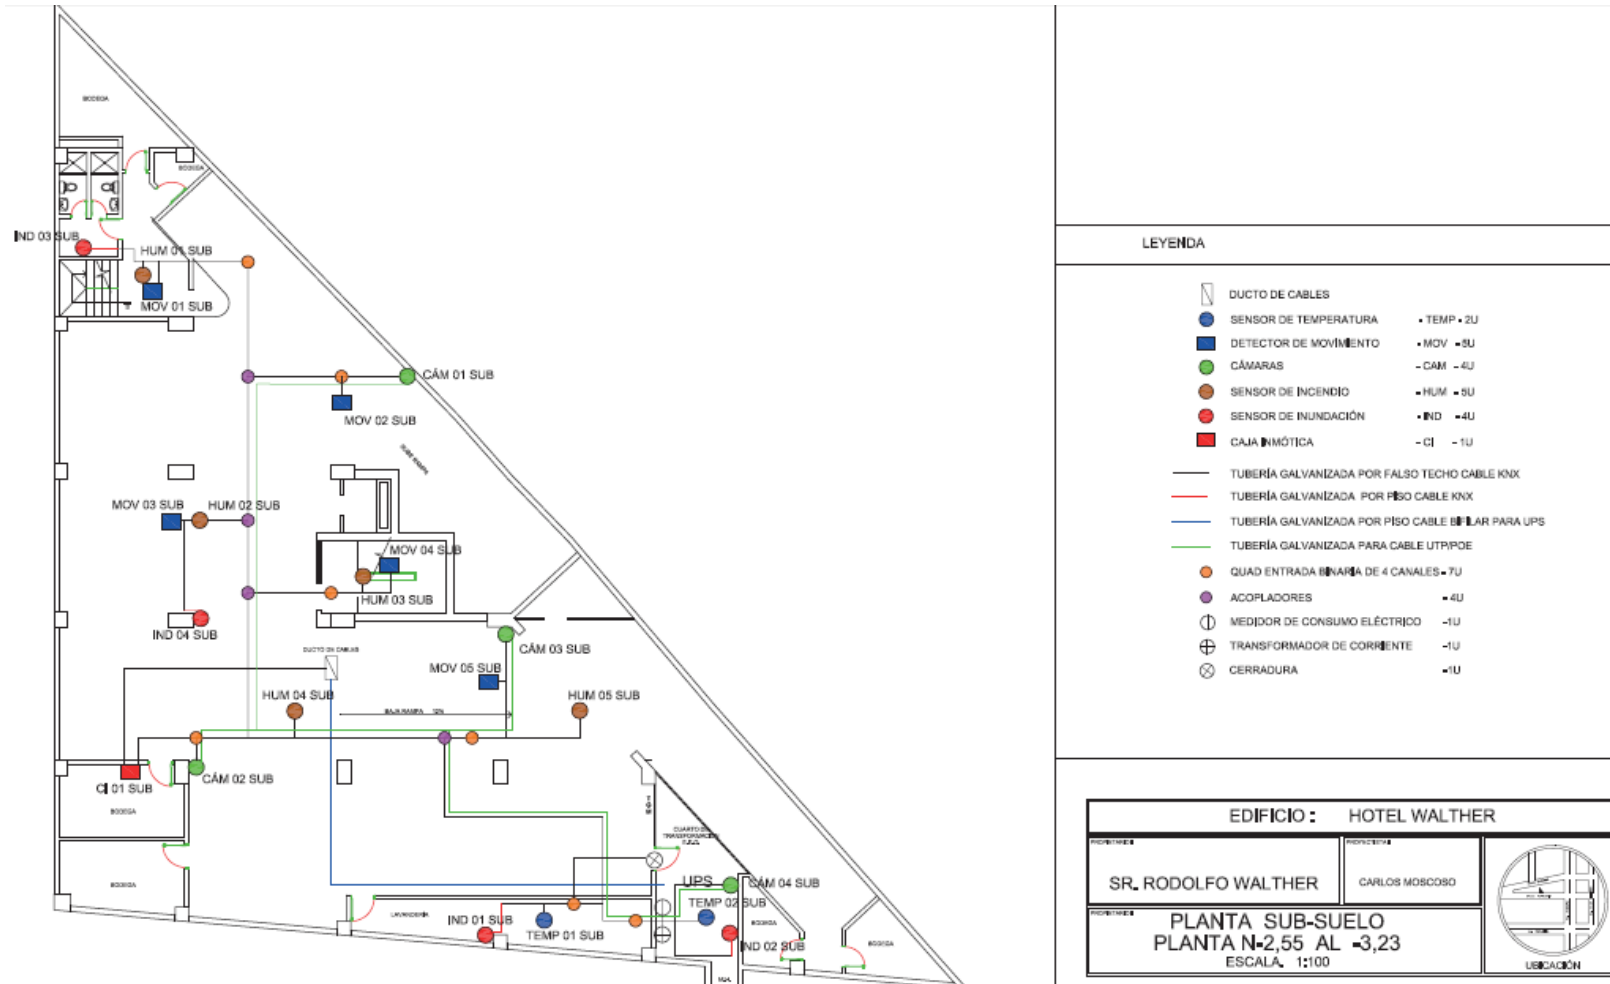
Planos de la red inmótica y la Internet en la Sub-planta
